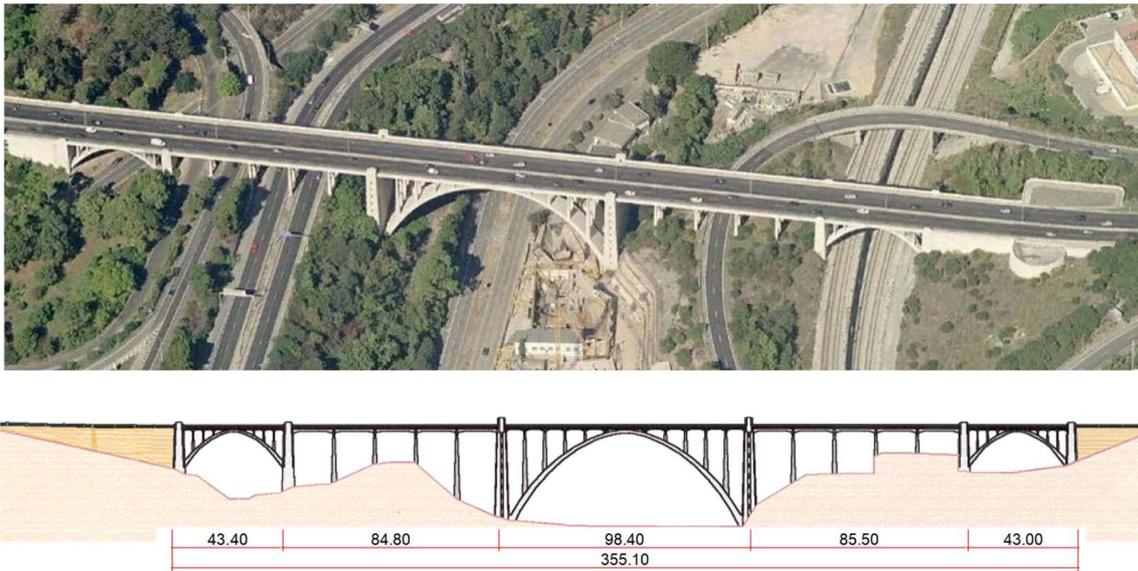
Vista do lado sul e alçado do lado norte do viaduto.
